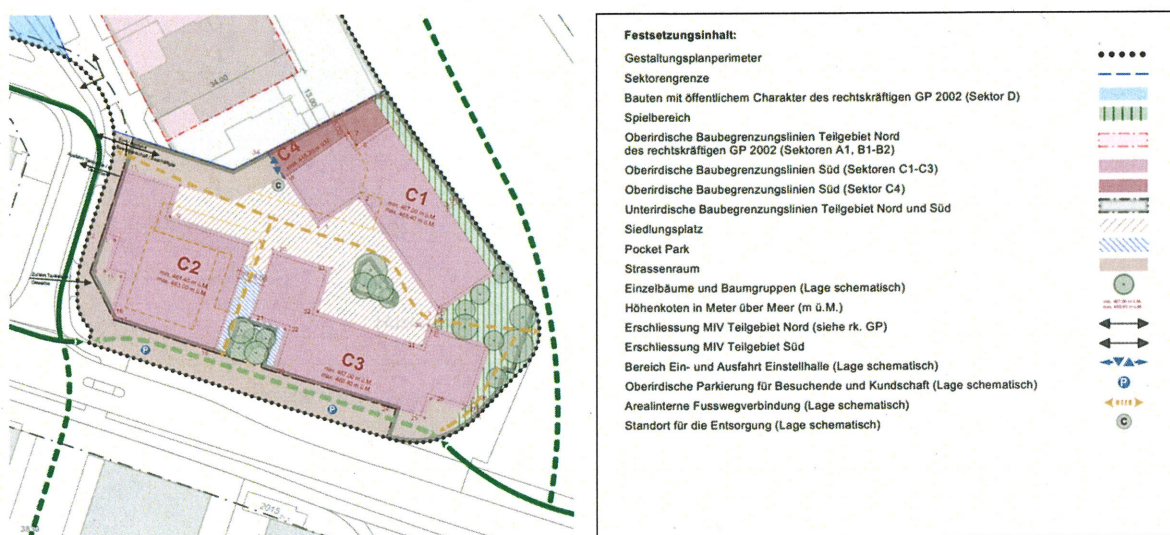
Planausschnitt Revision öffentlicher Gestaltungsplan Gwärfhölzli
